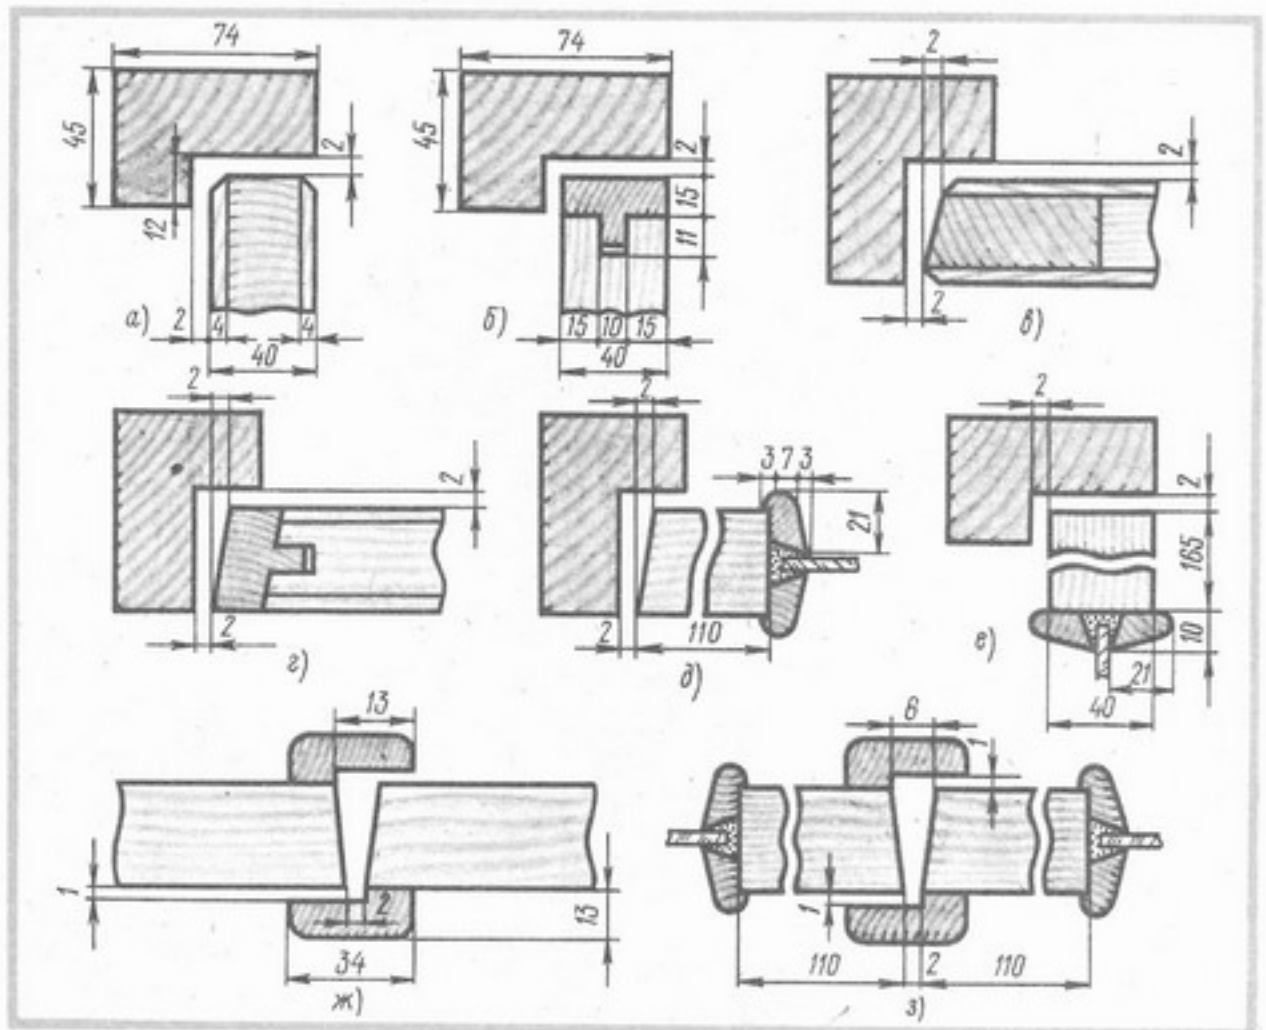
Сечения деталей дверных блоков щитовой конструкции:
